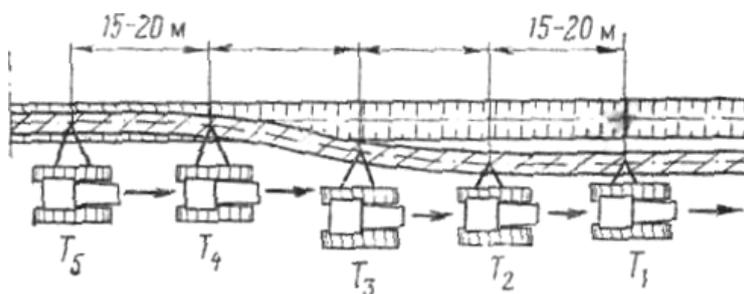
Схема укладки трубопровода «способом перехвата»
